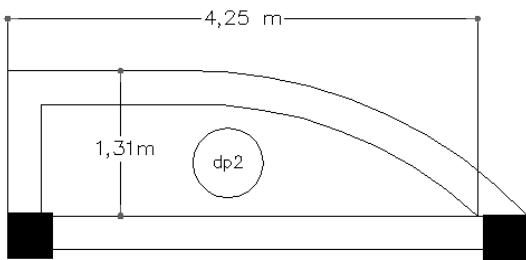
dalle pleine sur deux appuis (étage courant).
